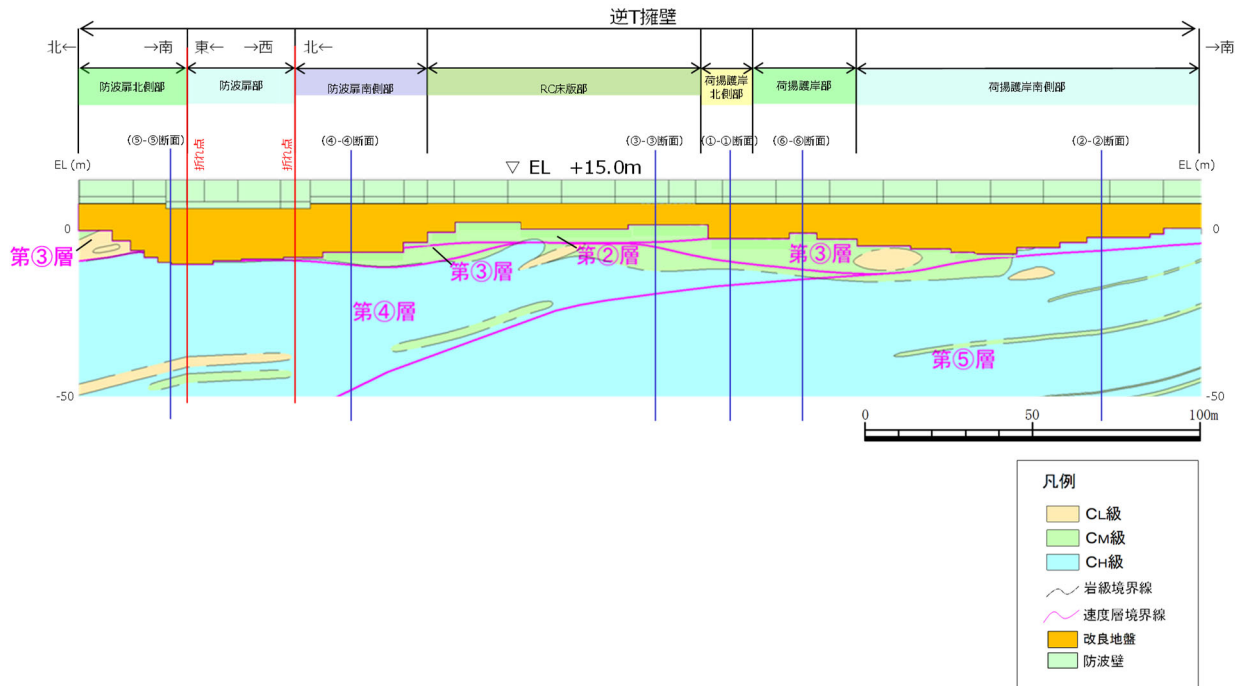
防波壁（逆 T 擁壁）縦断面図
